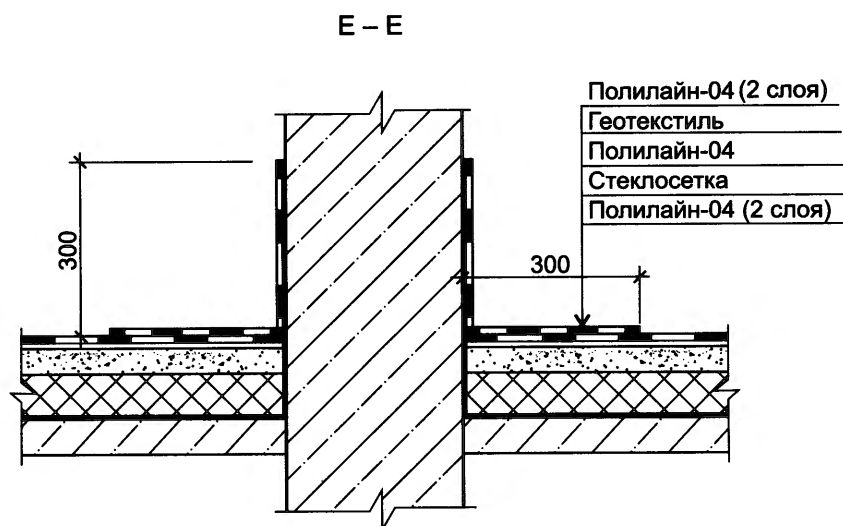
Гидроизоляция узла примыкания пола к колонне
